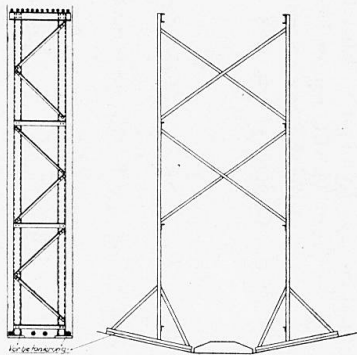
Chevalets de montage pour les armatures = Montageböcke für die Bewehrung = Scaffolding for erecting reinforcement.
